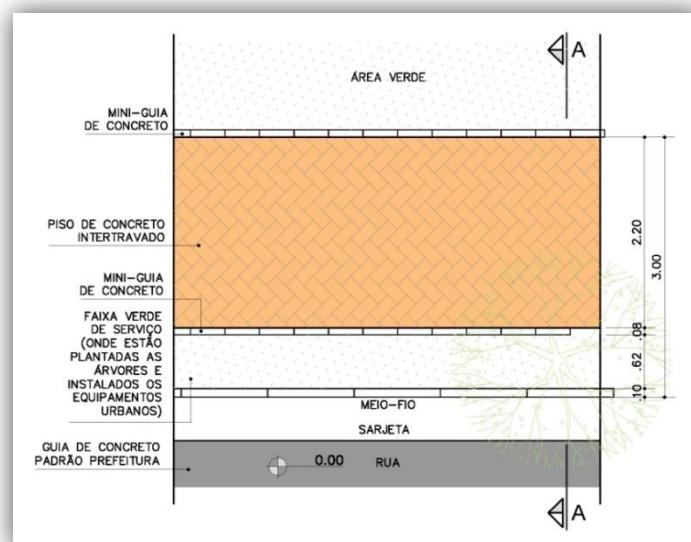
Planta do detalhe tipo 4: Passeio Público largura 3,00m; sem escala.
